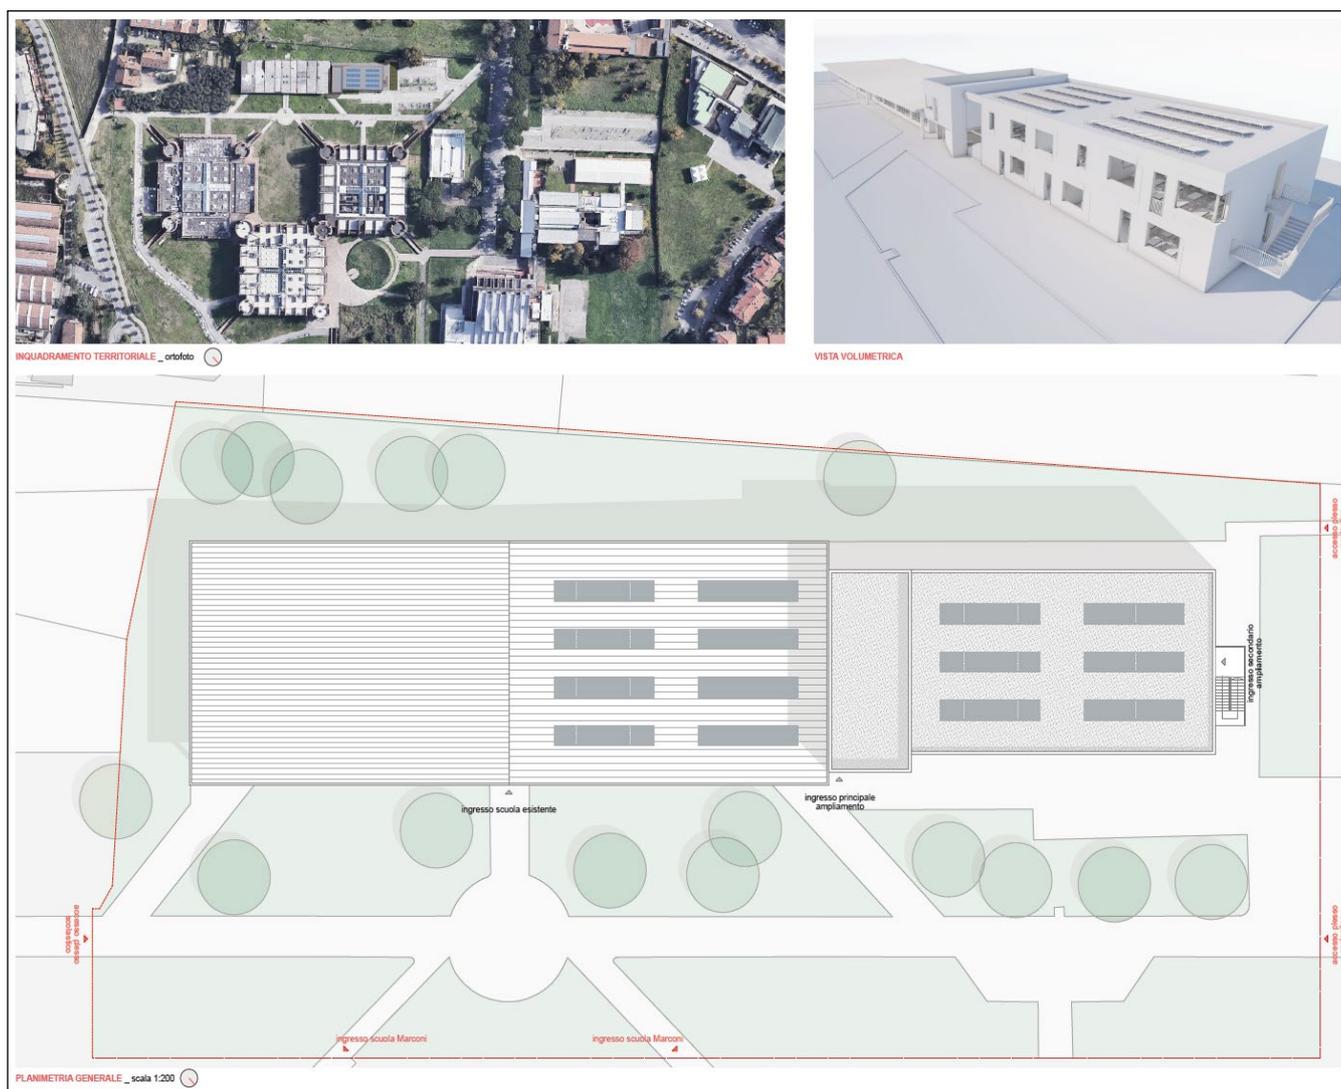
PLANIMETRIA INQUADRAMENTO STATO DI FATTO ATTUALE AMBITO
